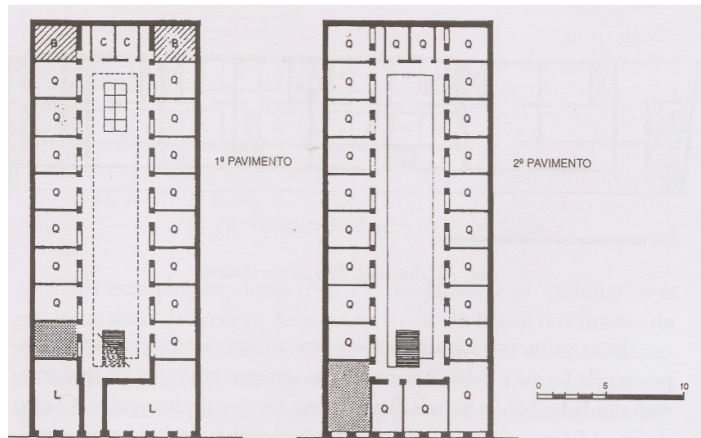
A – Plantas baixas da estalagem da Rua Senador Pompeu
